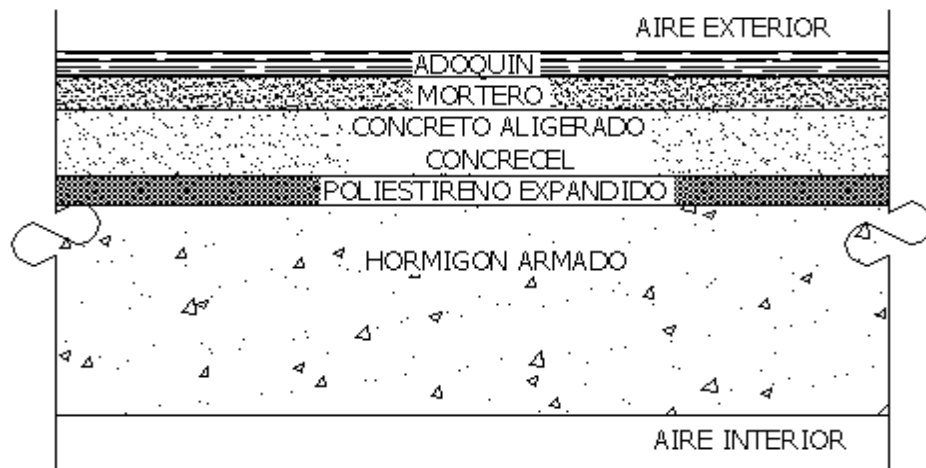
Detalle de la losa de cubierta del edificio
